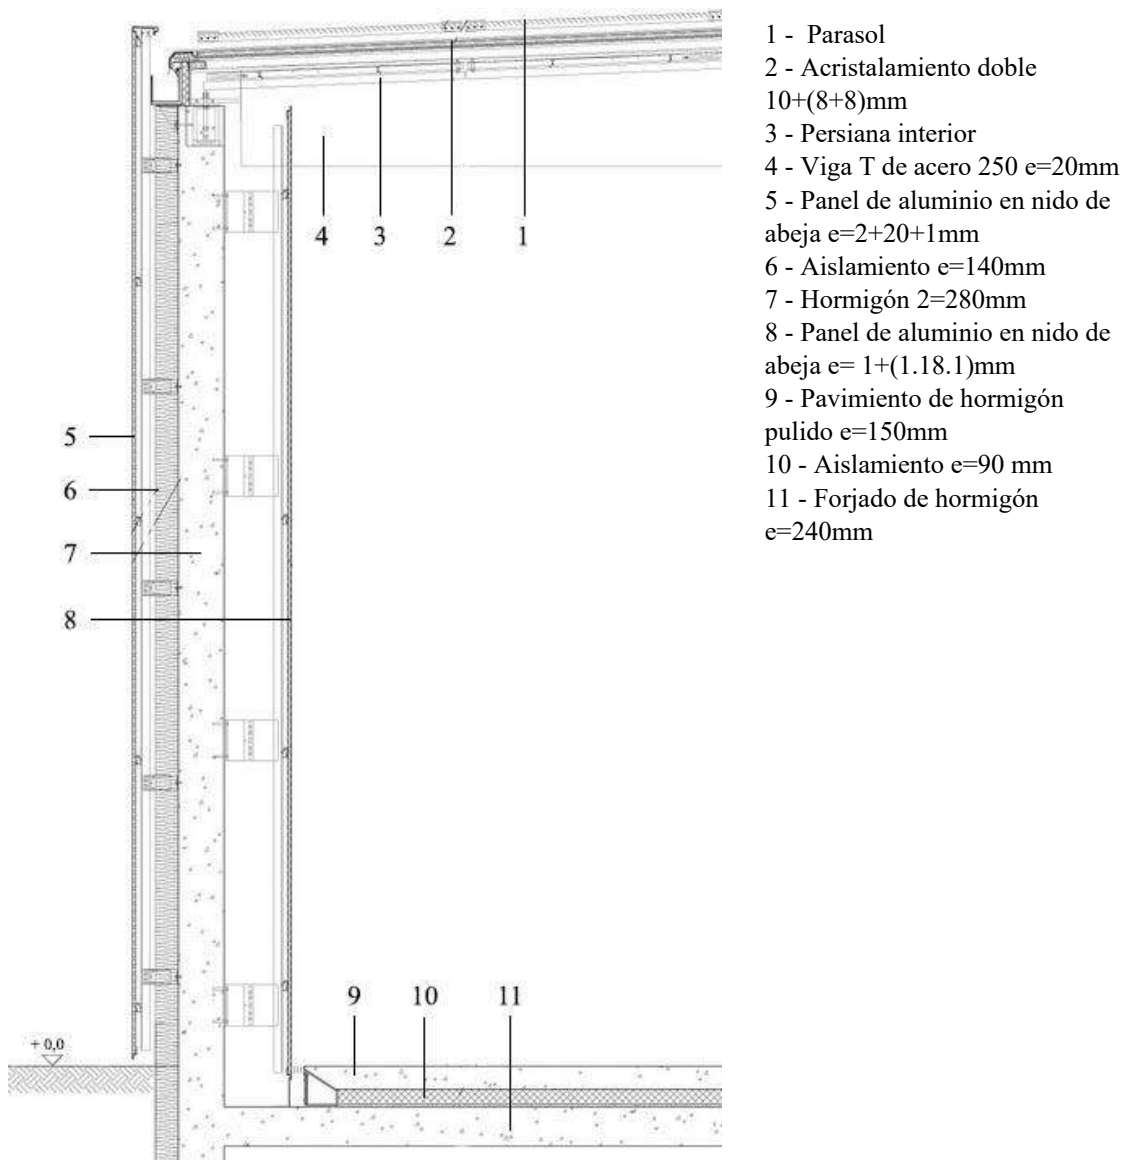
Sección constructiva del muro del pabellón de los Tiempos [65]
